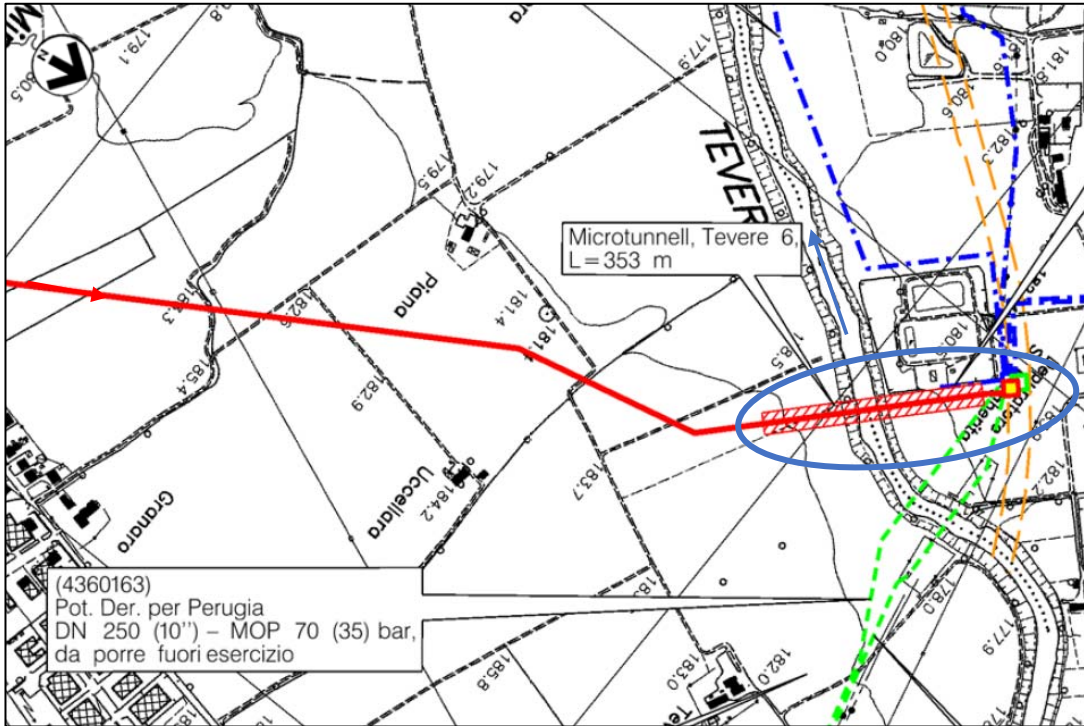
/B – Stralcio CTR con localizzazione dell'attraversamento
